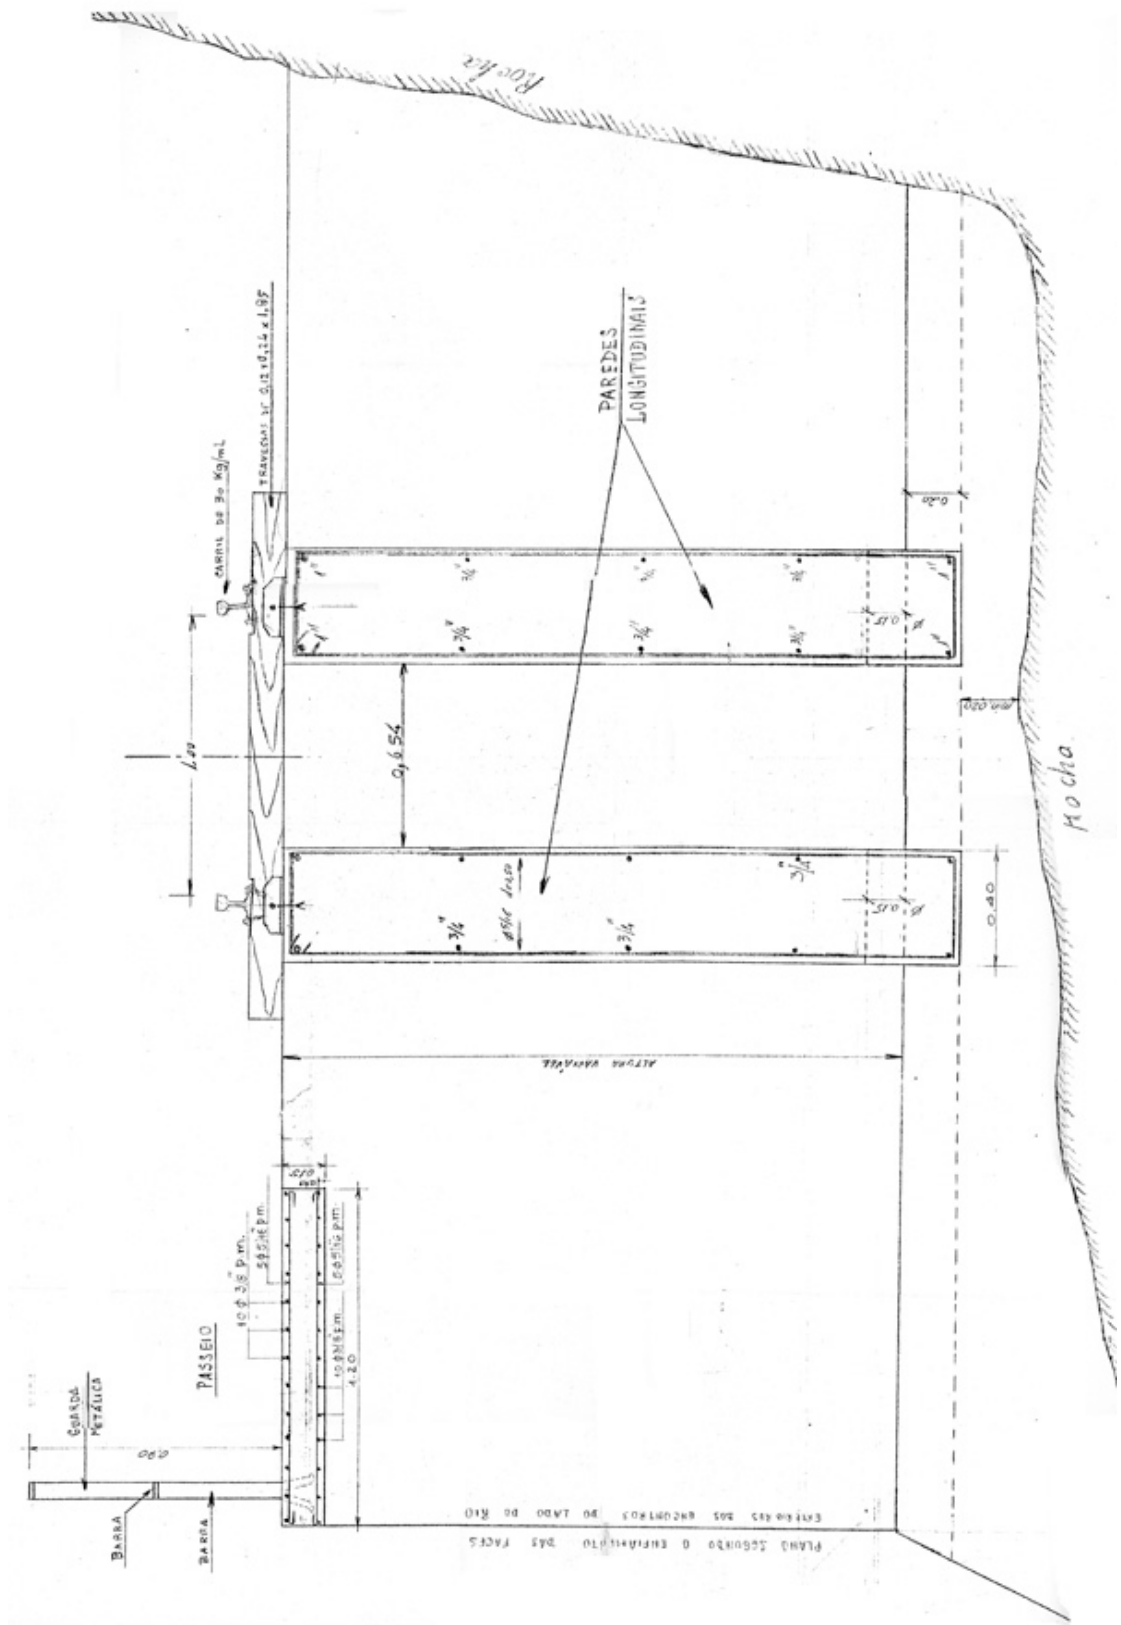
Viaduto das Fragas Más – estrutura de betão armado – parede longitudinal (fonte: REFER)
